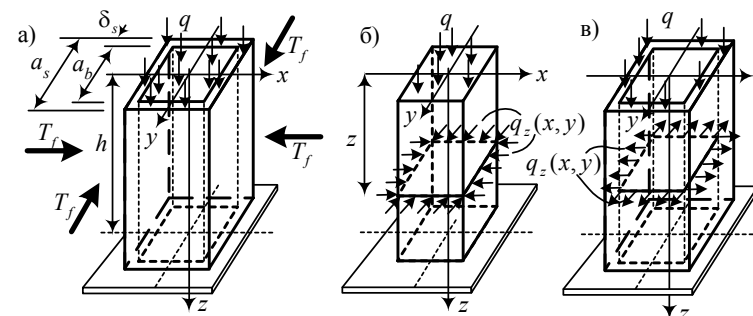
Расчетная схема консольной сталебетонной колонны: а) колонна; б) бетонное ядро; в) стальная обойма
